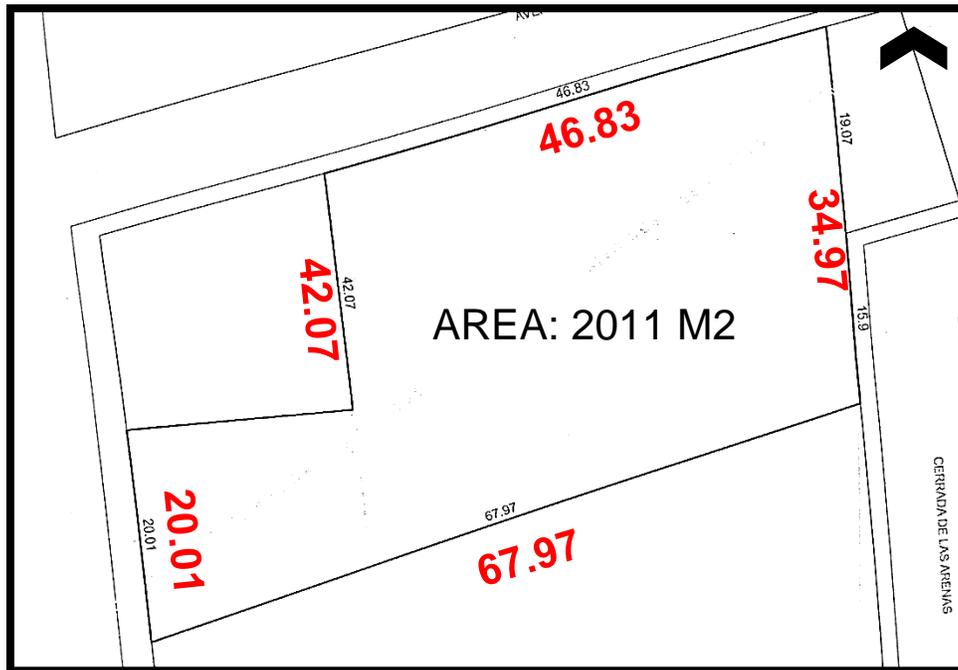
Terreno del proyecto. Fuente: Archivo personal de M. García. 2018
